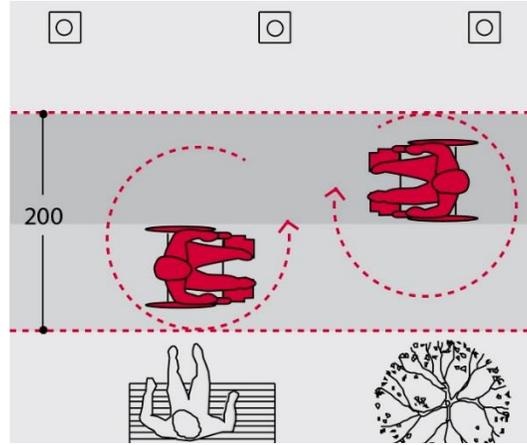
Ancho adoptado para caminamientos. (Accesible, 2010, pág. 38)
